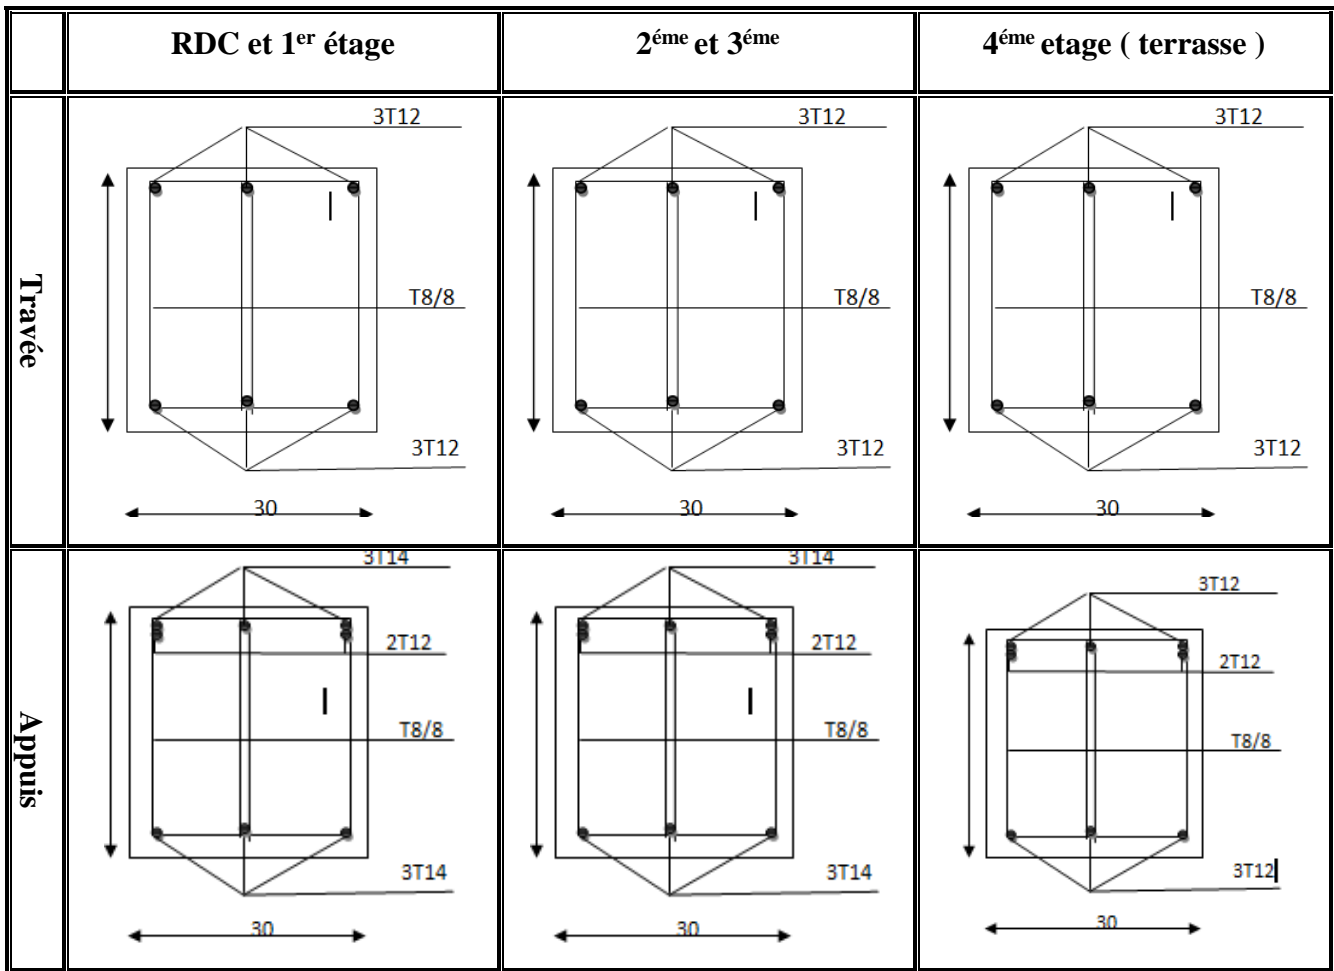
Schéma de Ferrailage des poutres secondaire
